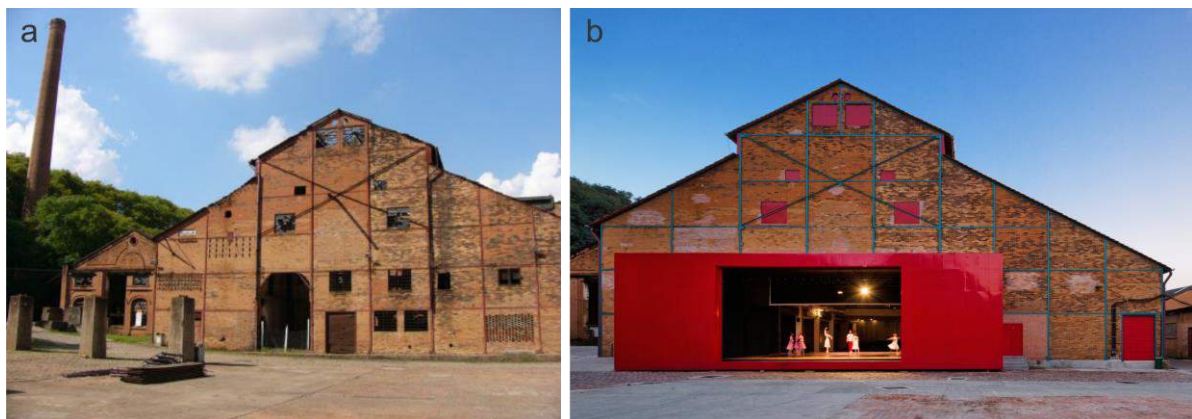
Teatro Engenho Central. a – vista da fachada frontal do galpão “6” antes da intervenção;
